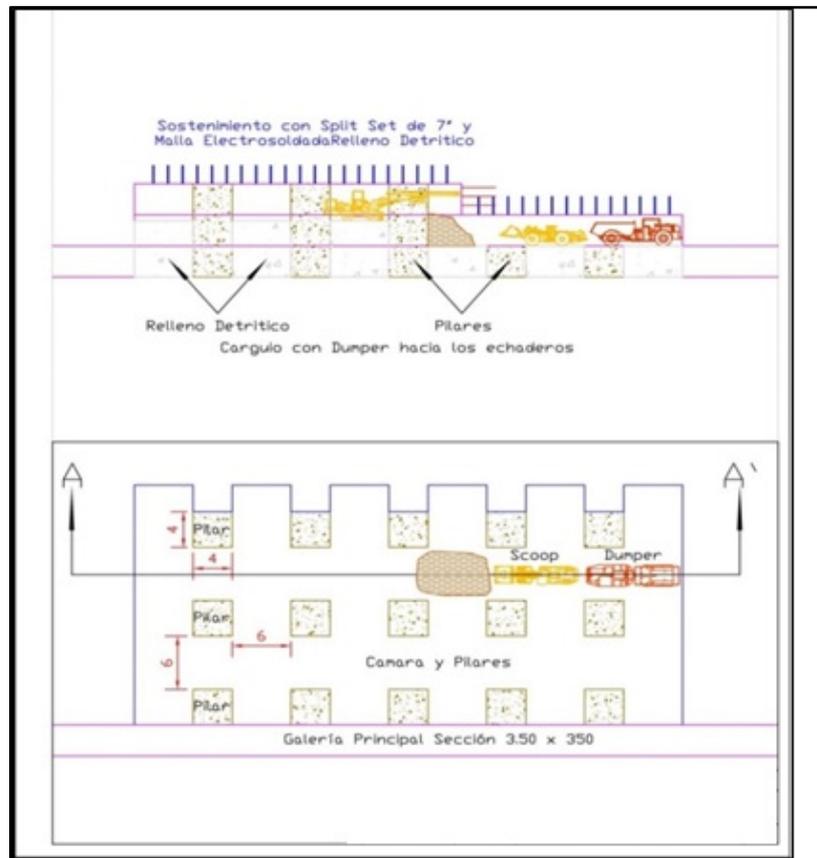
CAMARAS Y PILARES MECANIZADO
